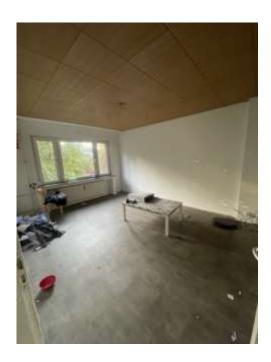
Zimmer Wohnung Roonstraße 69 2.OG links
